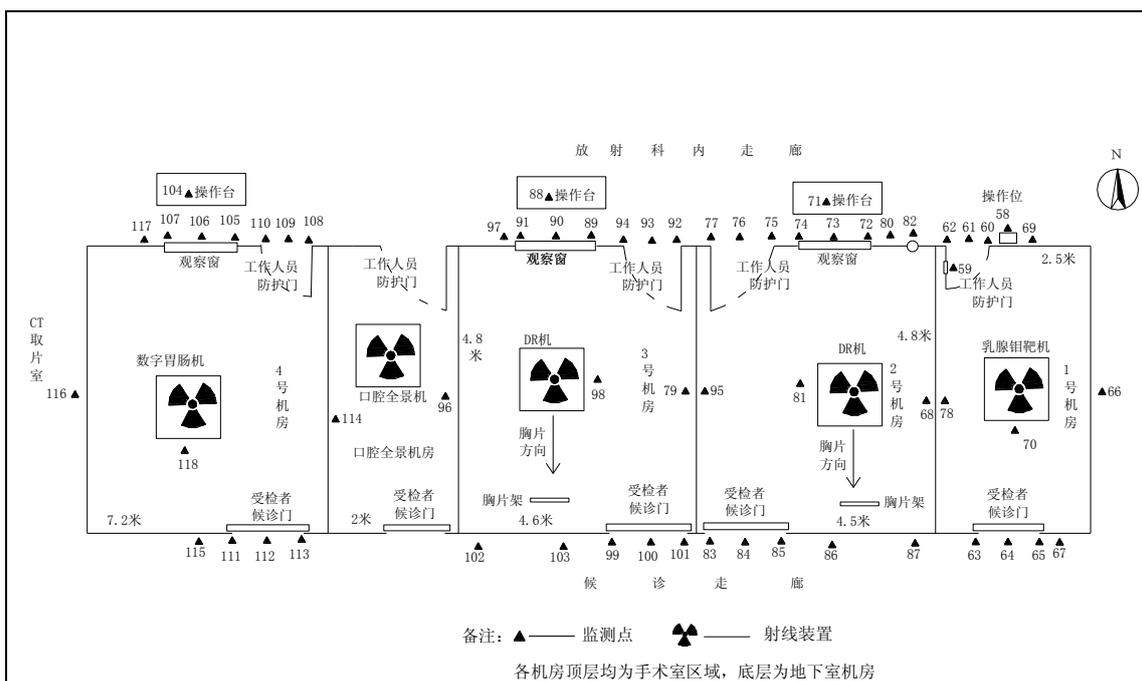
3#病房楼放射科 1 号~4 号机房现场监测点平面图
